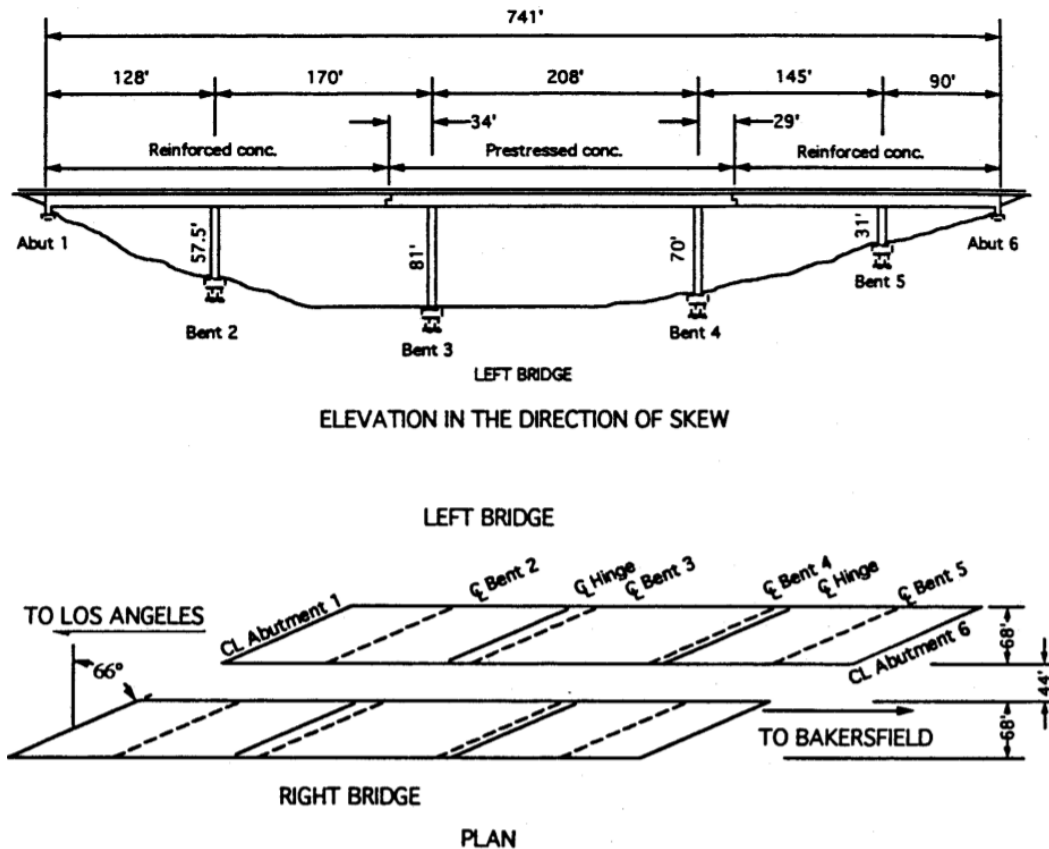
Elevación y Planta del Paso Inferior Gavin Canyon. Fuente: [11].
